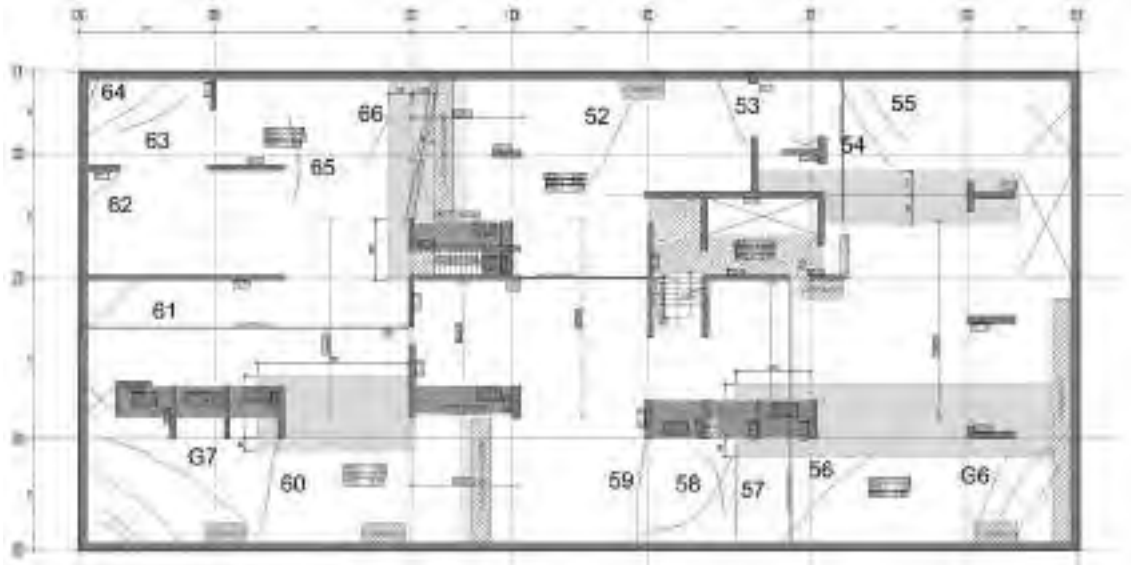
Ubicación de fisuras en sótano 6
